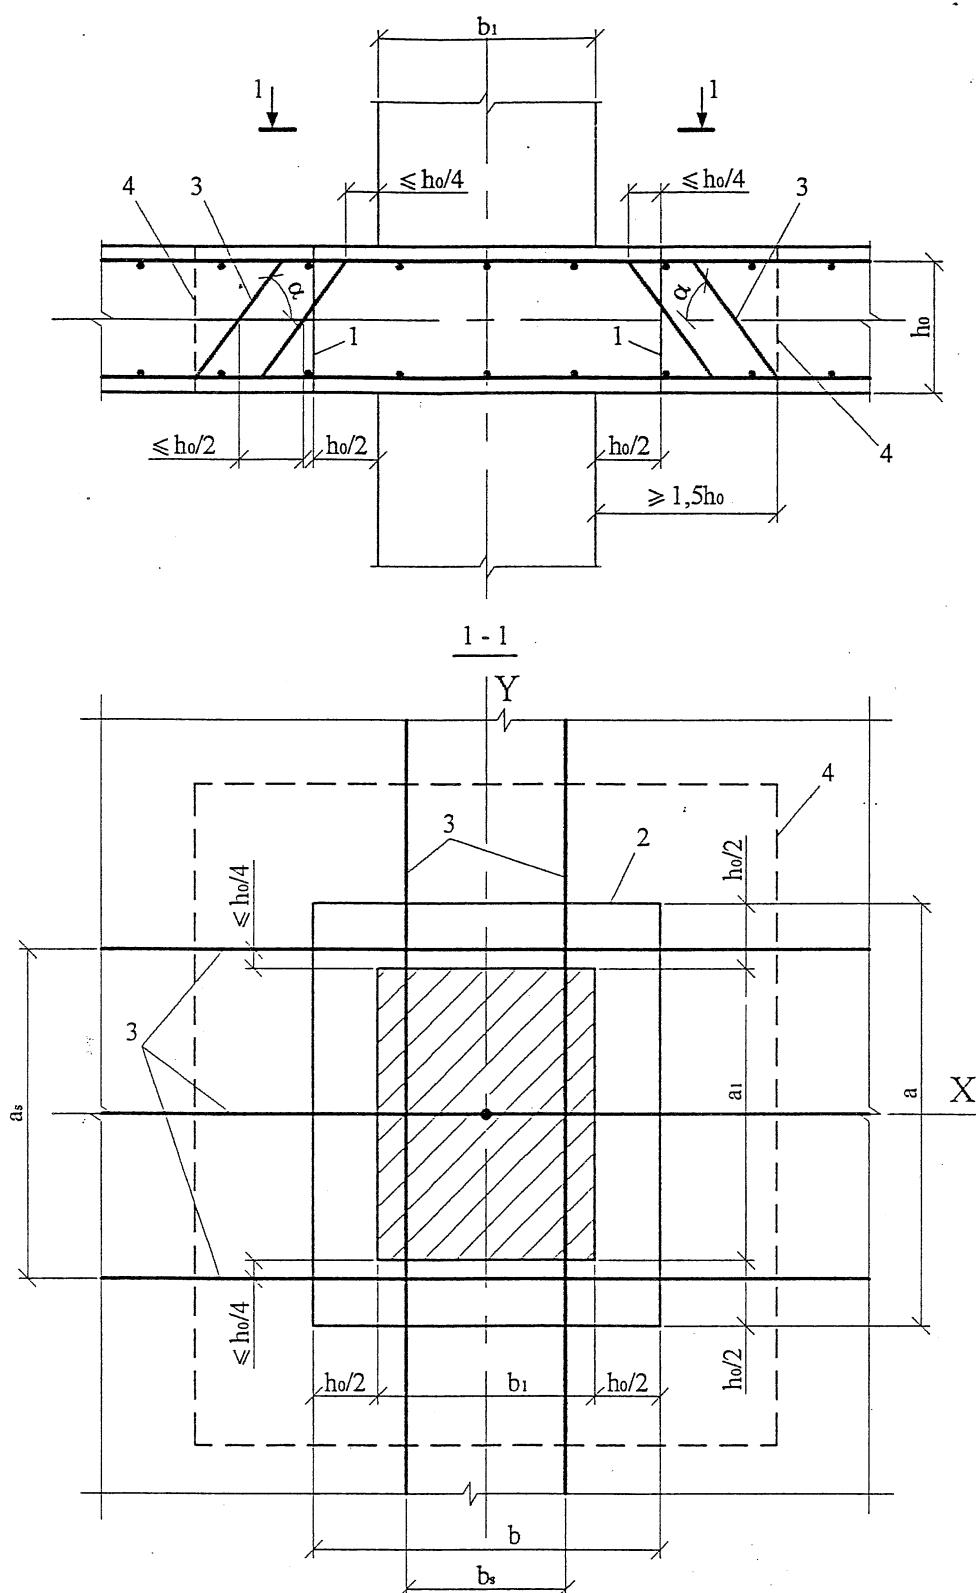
Схемы для расчета железобетонных плит с поперечной арматурой в виде отгибов на продавливание
